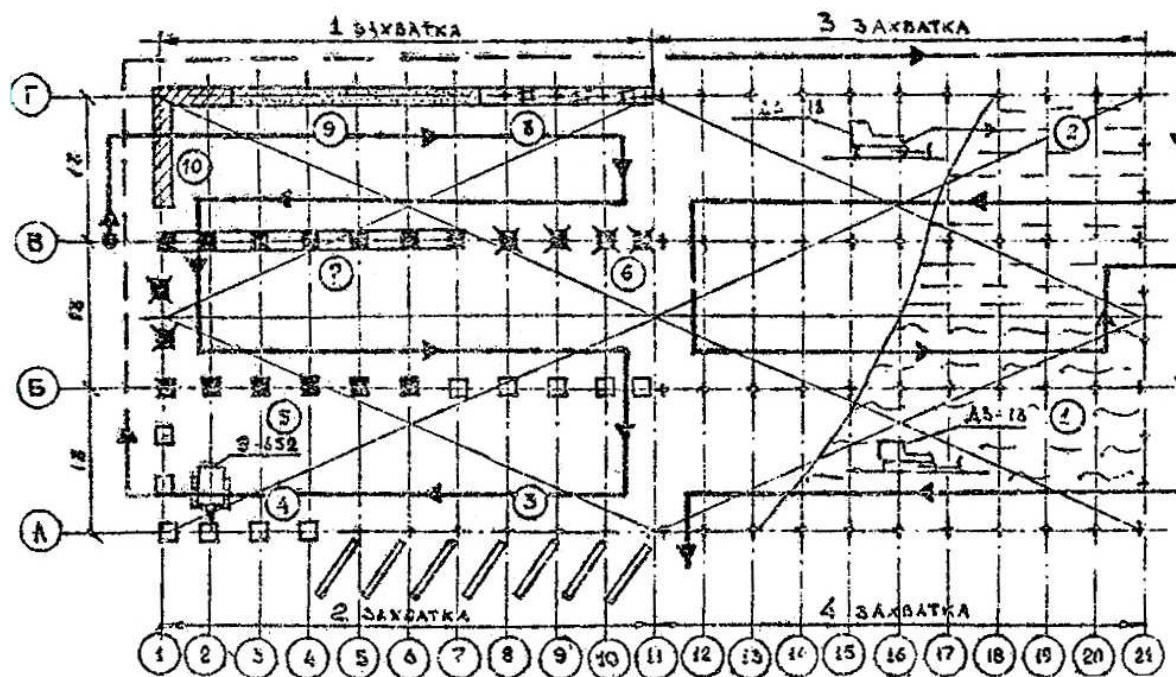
Схема организации свайных работ на строительной площадке: 1 – 10 – порядок производства работ на площадке; → – путь движения копрового агрегата
